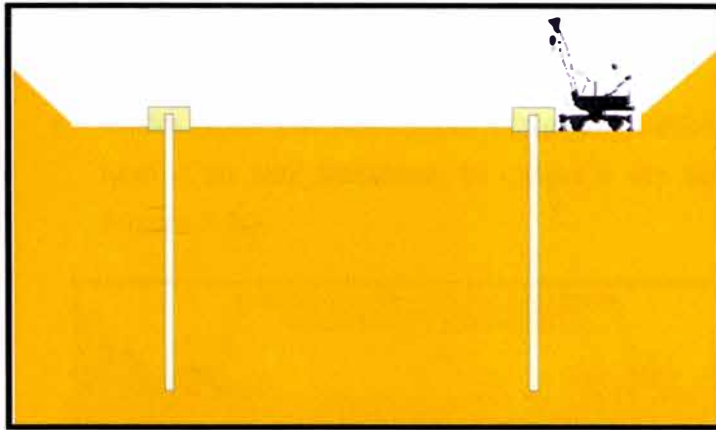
Vaciado de las vigas collarín – carrileras para transmitir las cargas al muro de tablestacas.
